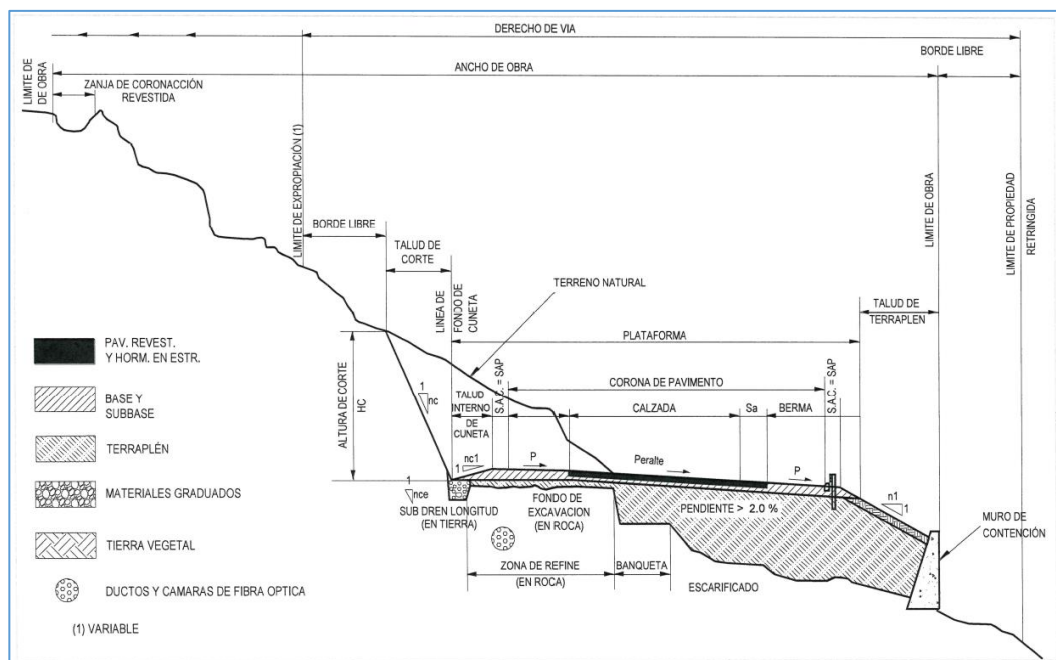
Componentes de un Pavimento en una Vía a Media Ladera
